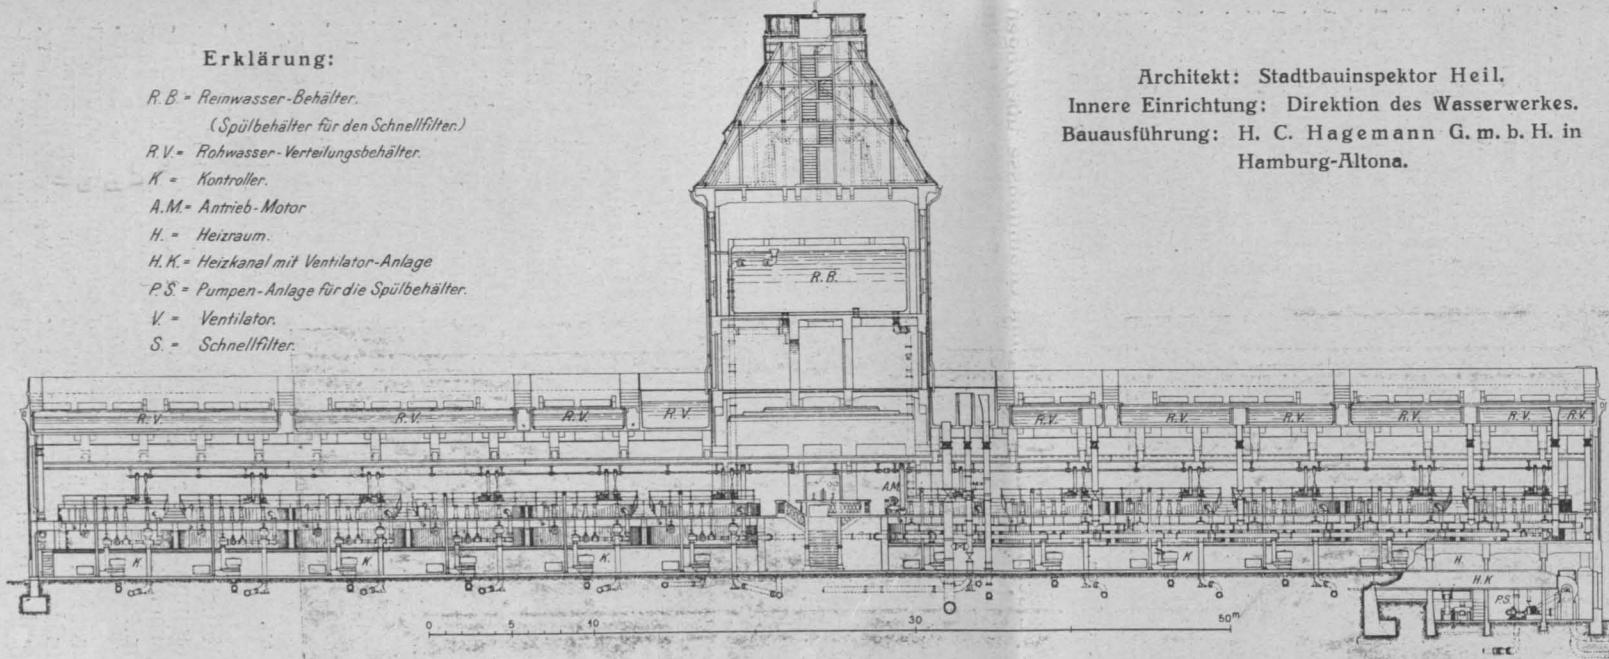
Längsschnitt durch das Schnellfilter-Gebäude.
